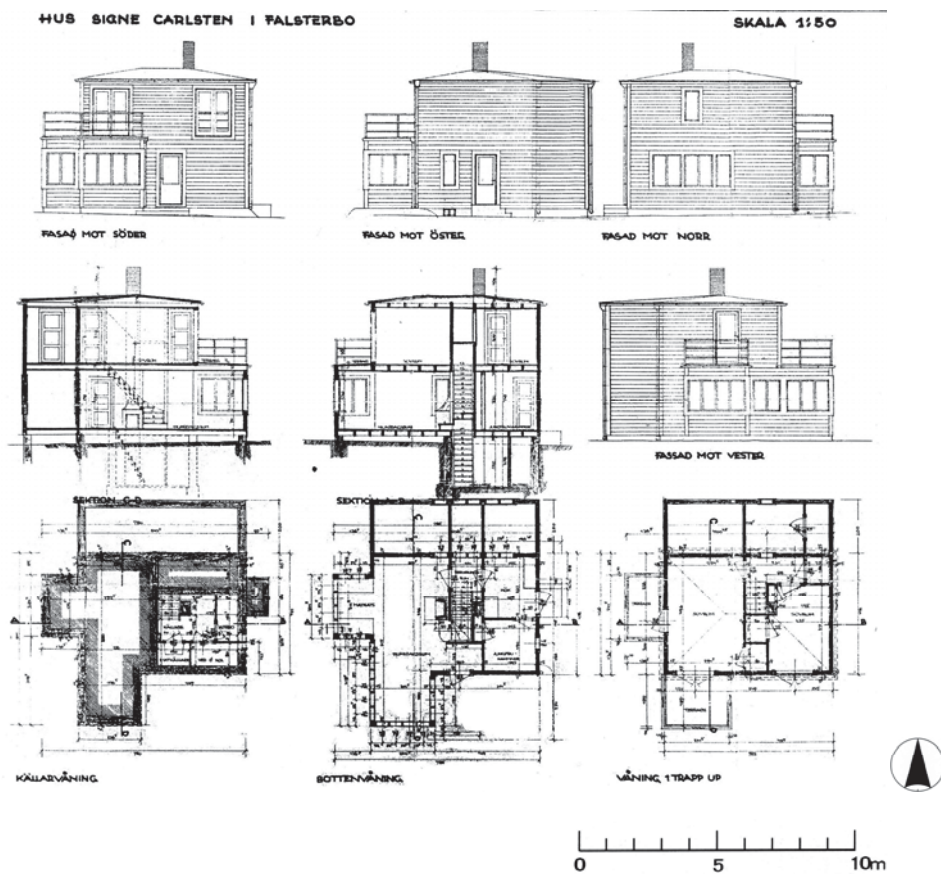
ヴィラ・カールステン 平面図・立面図・断面図
